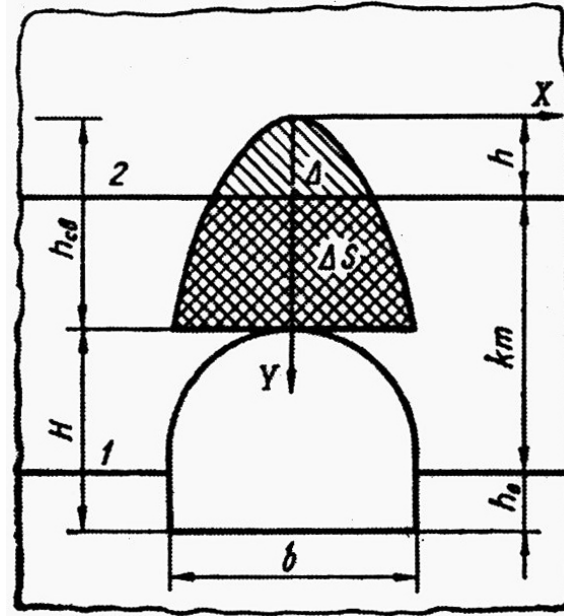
Расчетная схема для определения нагрузки на крепь выработок, расположенных в обрушенной и уплотненной толще пород выработанного пространства
